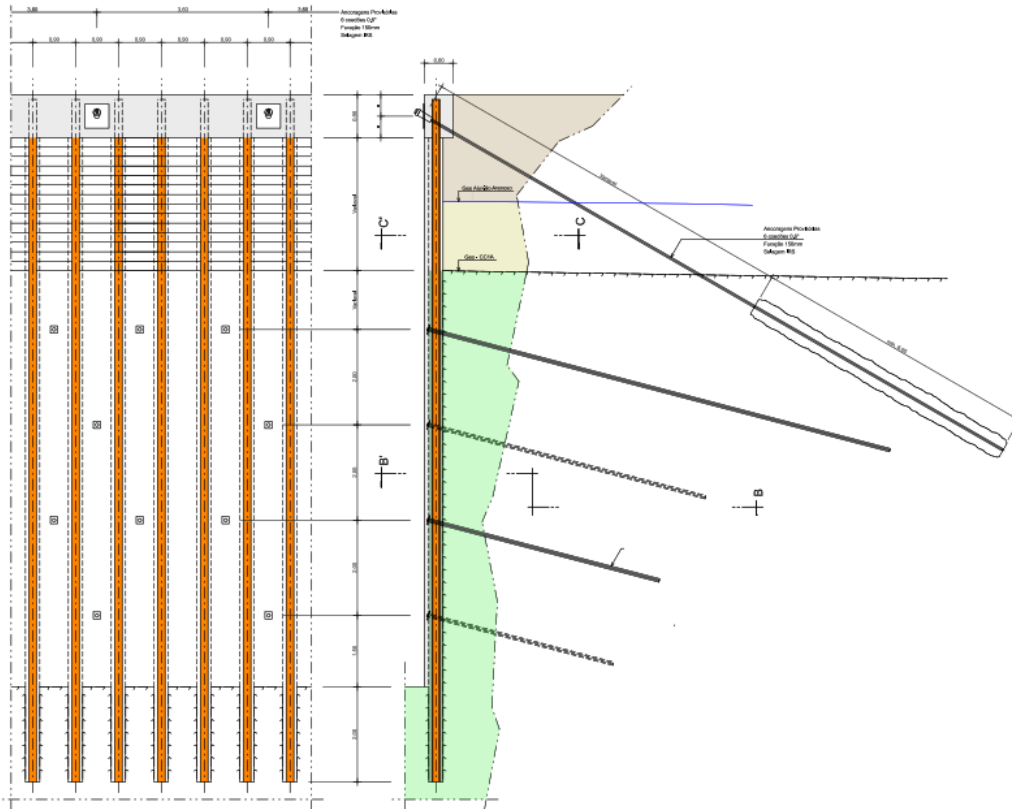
Alçado e corte tipo da solução típica de contenção
